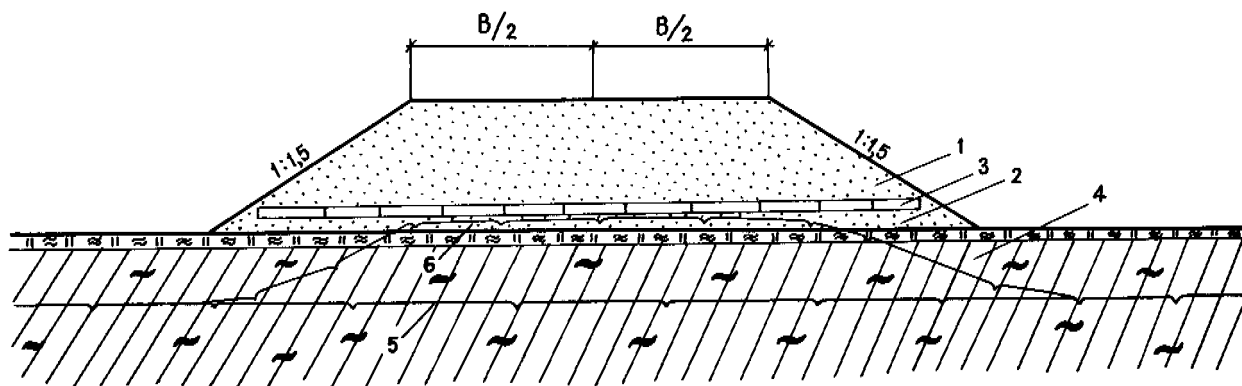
Конструкция земляного полотна с теплоизоляционным слоем из пенопласта (пенополистирола):
